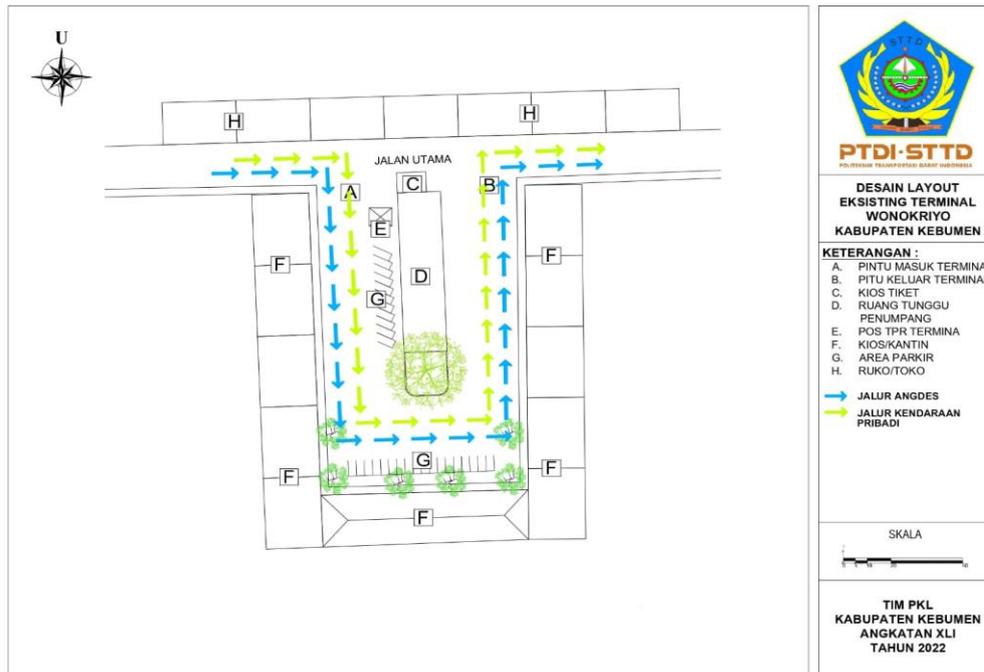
Layout* Terminal Tipe C Kebumen
